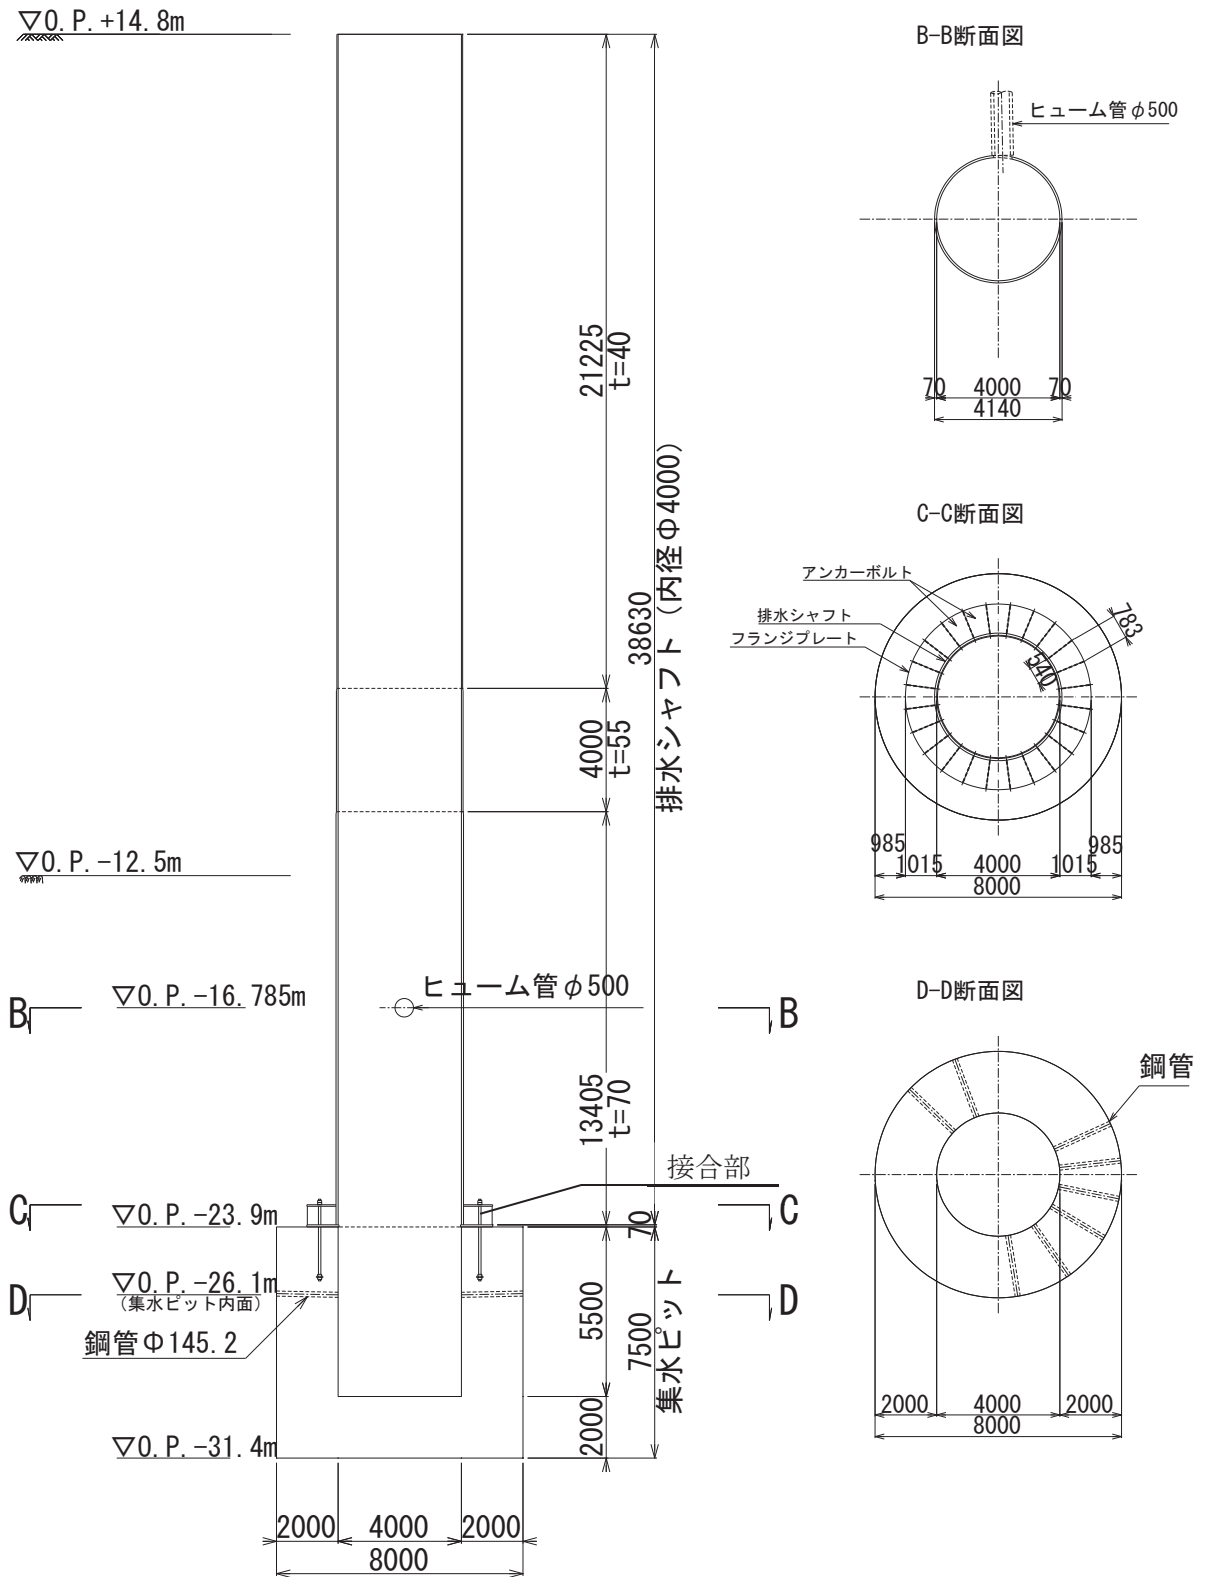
(3) No. 3 揚水井戸 構造概要 (単位: mm)
